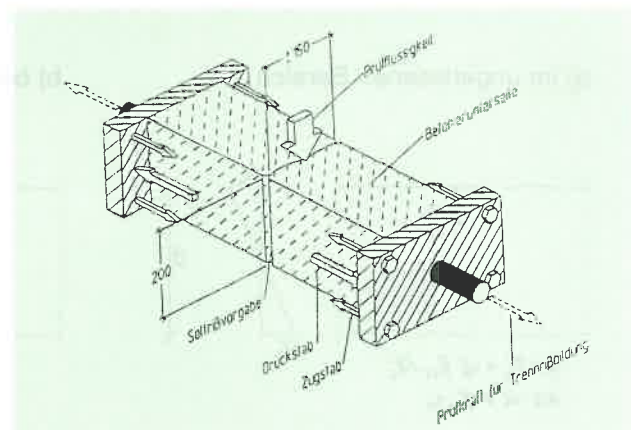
Prüfkörper zur Bestimmung der Eindringtiefen in gerissenen Beton nach [6]
